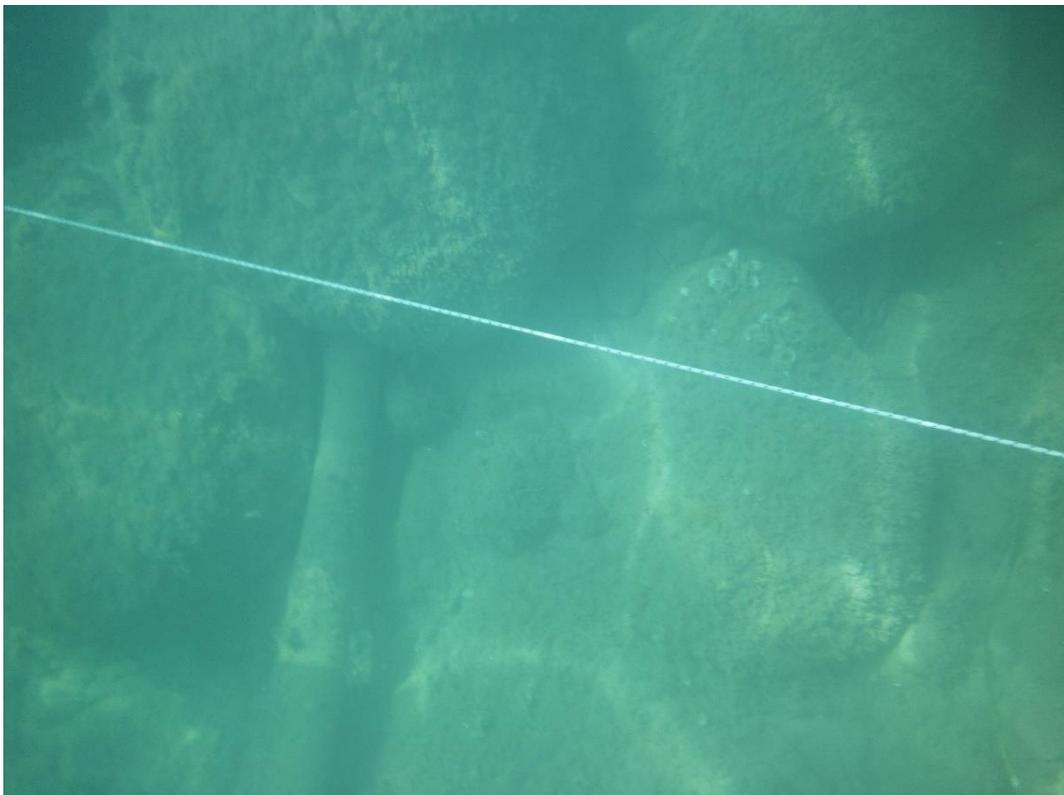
fondale Diga di Ponente 20 m dalla costa circa
